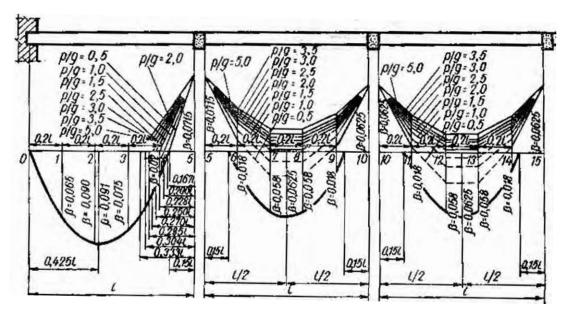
Эпюры расчетных моментов для равнопролетных неразрезных второстепенных балок
